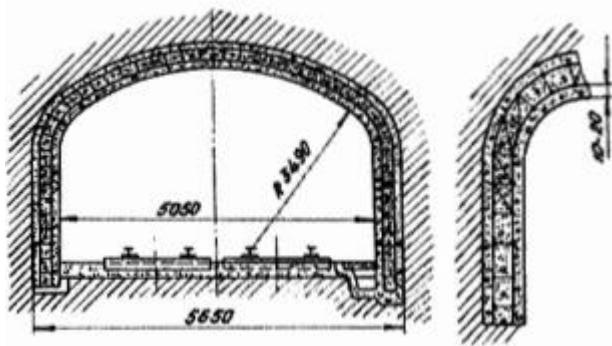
Монолитная железобетонная крепь с гибкой арматурой
